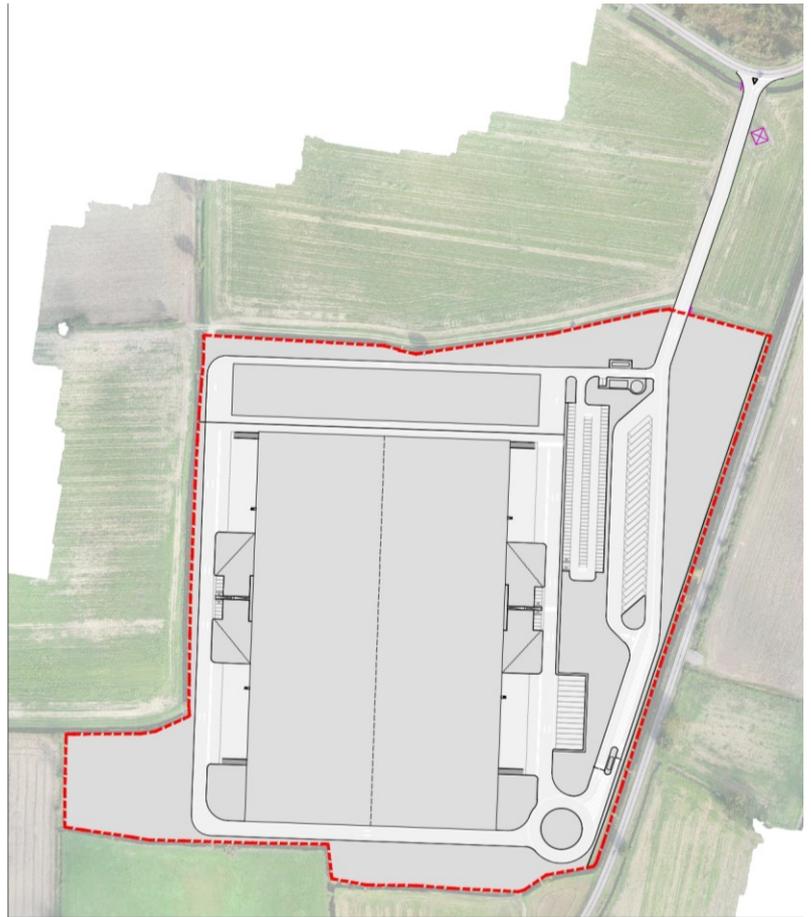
Estratto Tavola 00 di PA - "Planimetria individuazione lotto di proprietà comunale")
